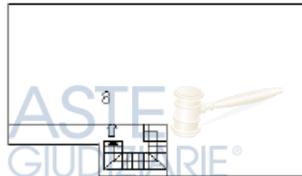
stralcio dell'Elaborato planimetrico catastale con individuazione dell'area di corte distinta con il subalterno 6
